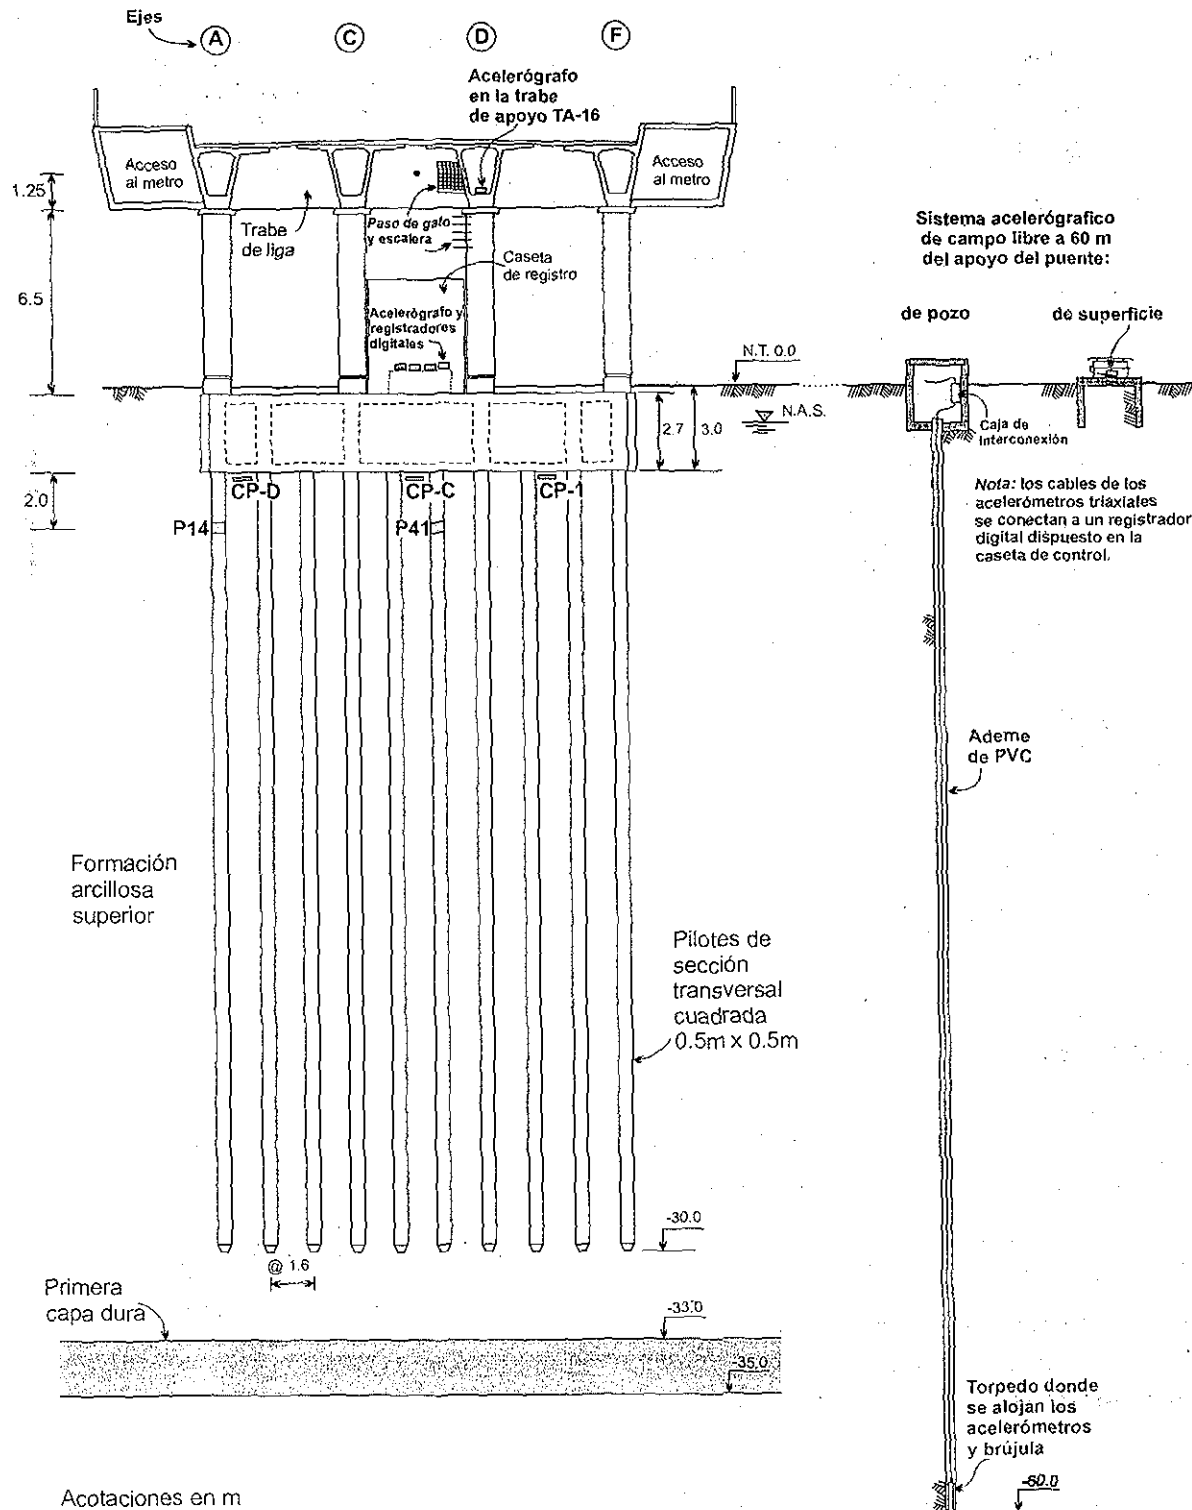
Vista transversal de la cimentación y superestructura del apoyo No. 6 del puente vehicular Impulsora
